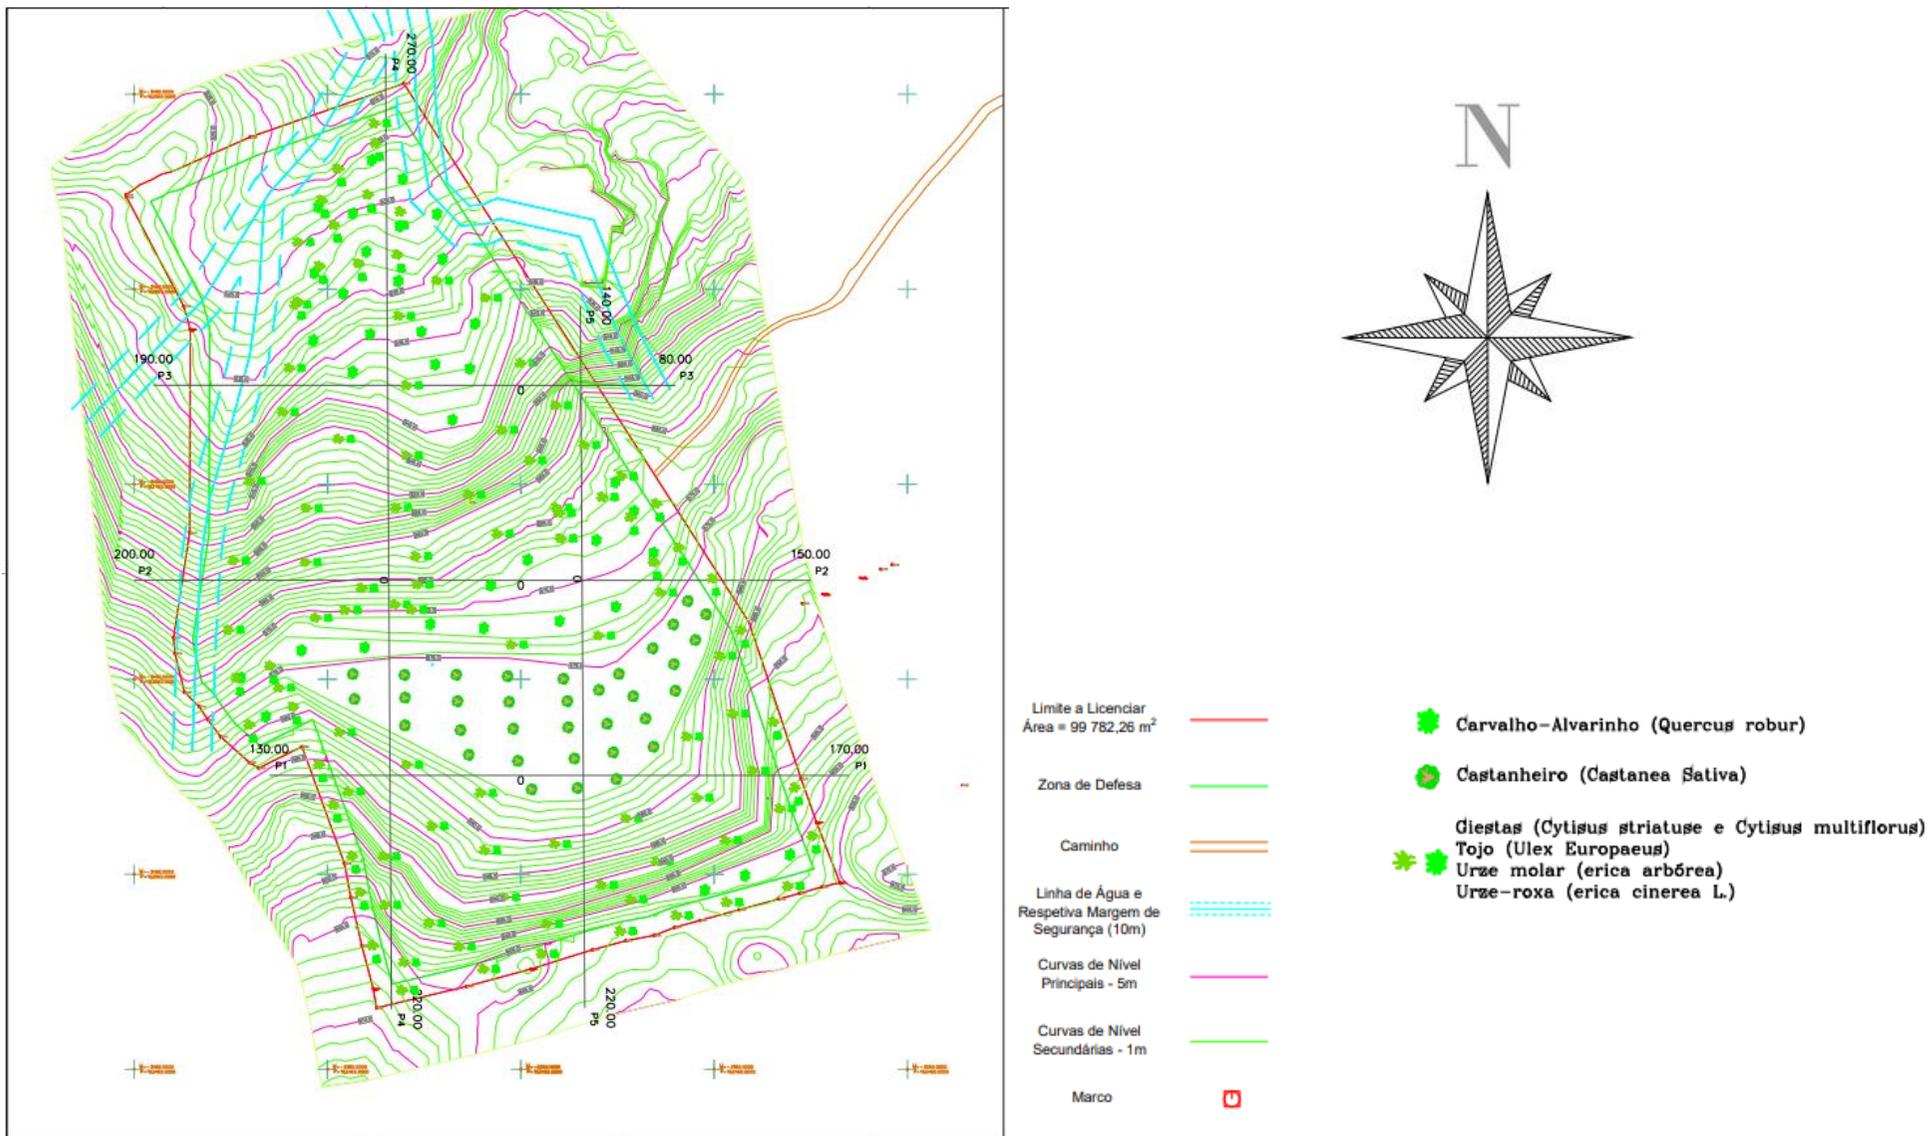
Planta de recuperação paisagística. Fonte: PARP
